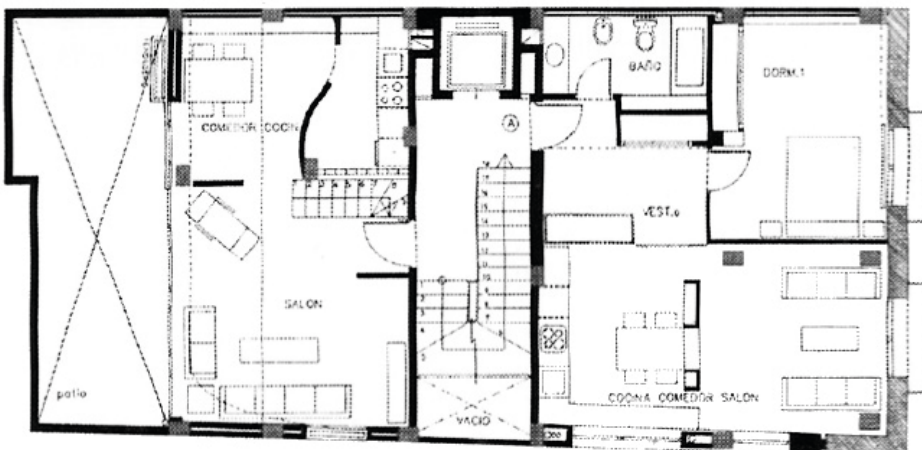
Carmen Rivera Gallego. Viviendas en la calle Labradores esquina calle Santo Tomás, Alicante, 1994-98. Planta tipo.
